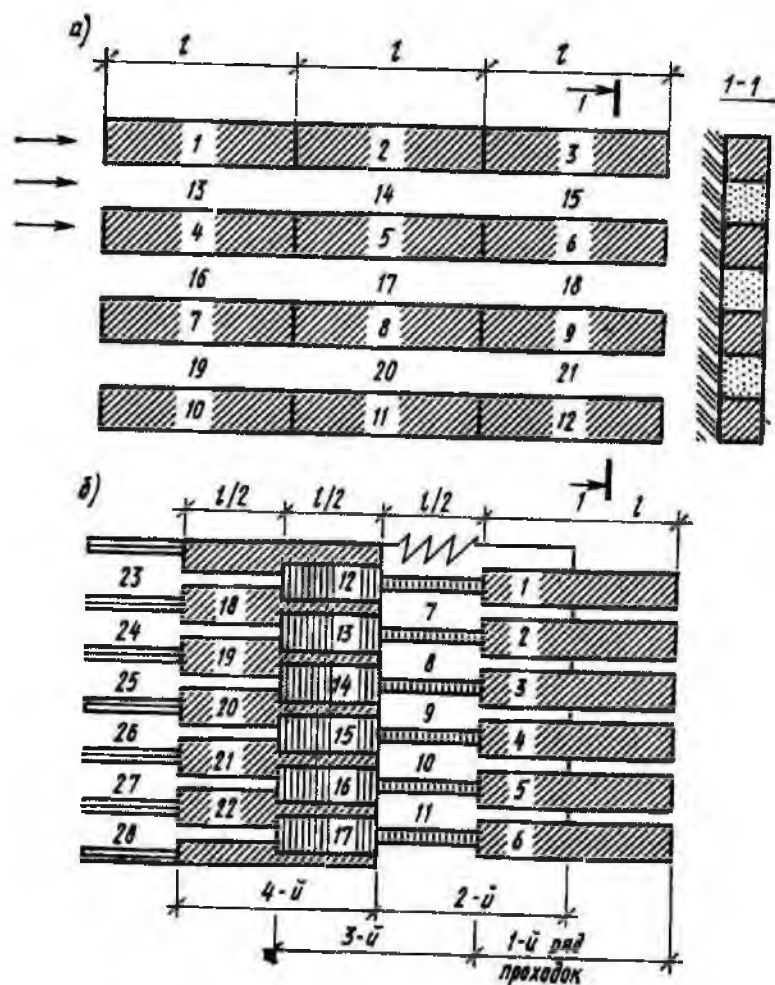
Схема разработки грунта скреперами при планировке площадок:
